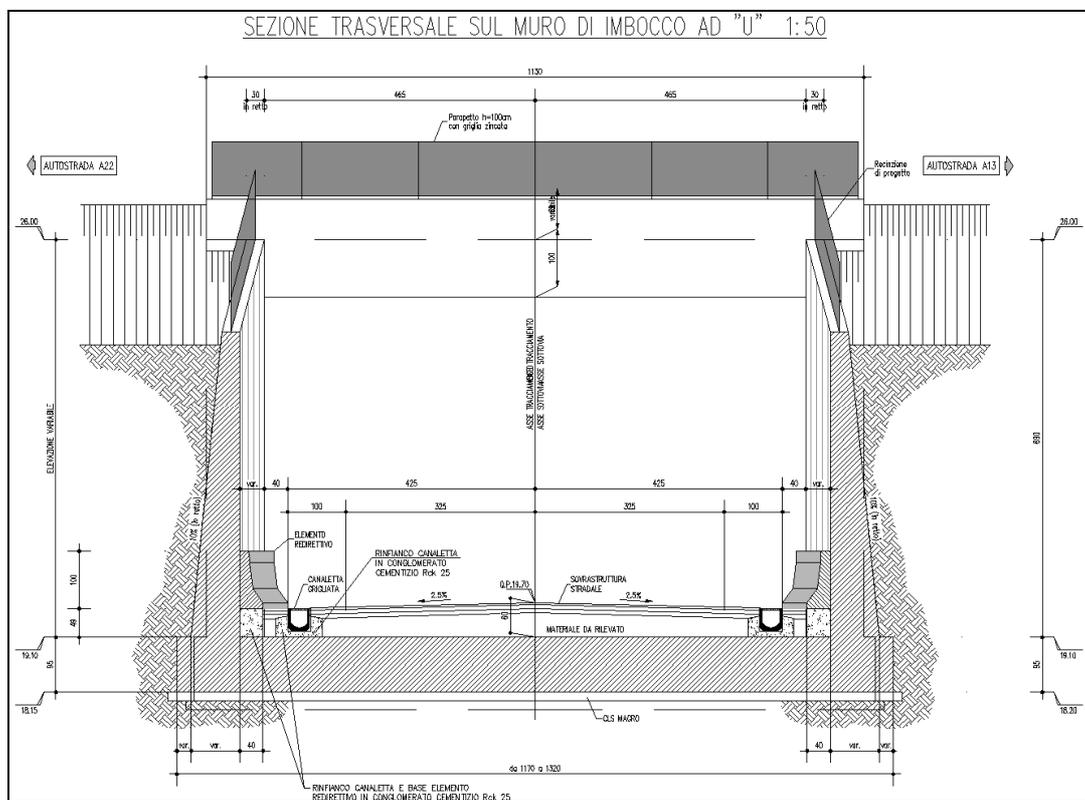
SEZIONE TRASVERSALE SUL MURO DI IMBOCCO AD "U"
